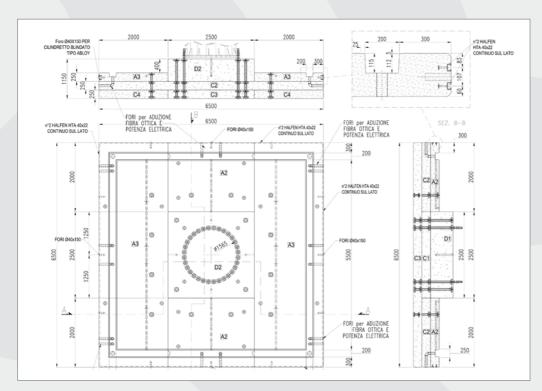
Pianta e sezione del FAST SITE® SYSTEM 36
